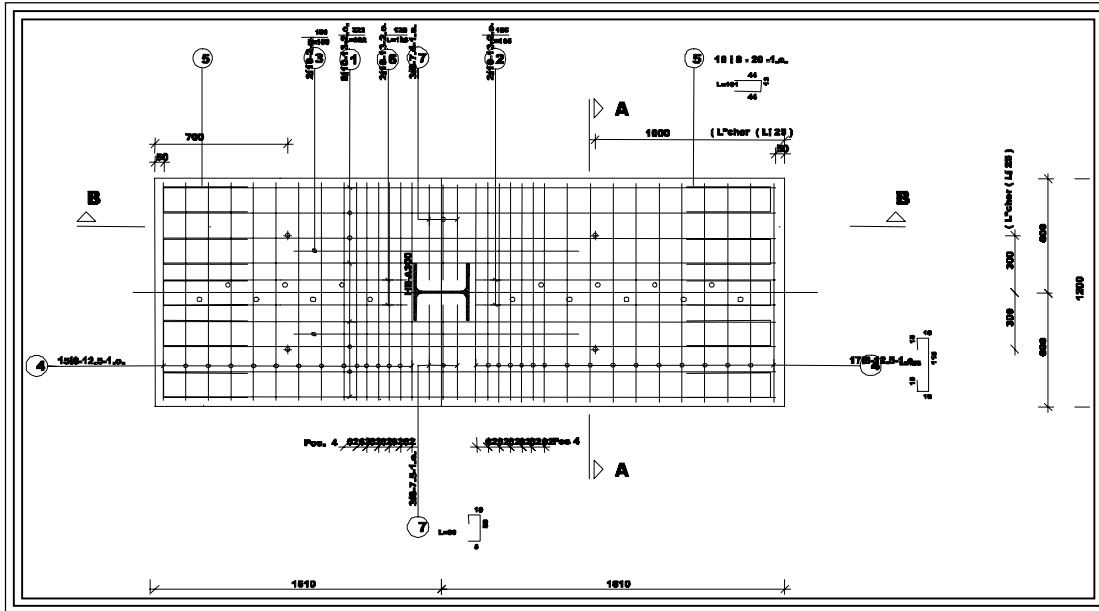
Grundriß des Versuchskörpers T5-1, mit Bewehrung
